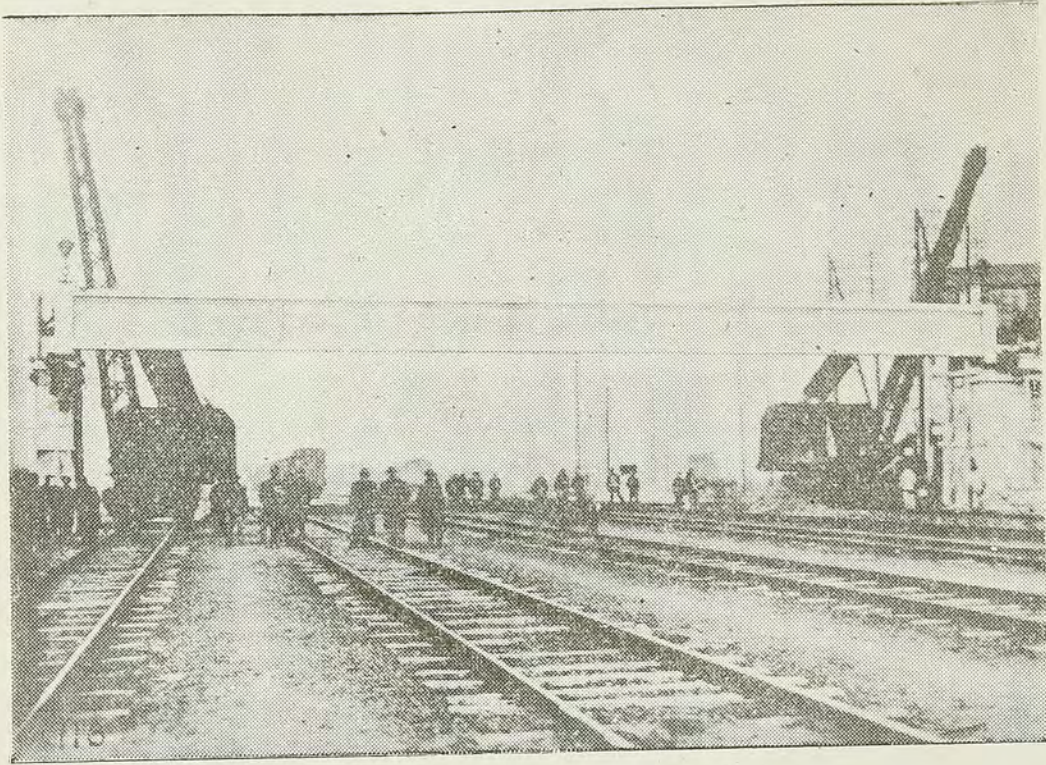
Colocación de una viga de cables estirados después de concretada.
